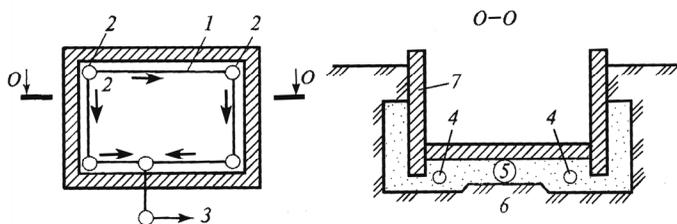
Пластовый дренаж (план и разрез): 1 – дрены; 2 – смотровые колодцы; 3 – сброс воды; 4 – дренажные трубы; 5 – крупнозернистый песок; 6 – грунт основания; 7 – фундамент здания
